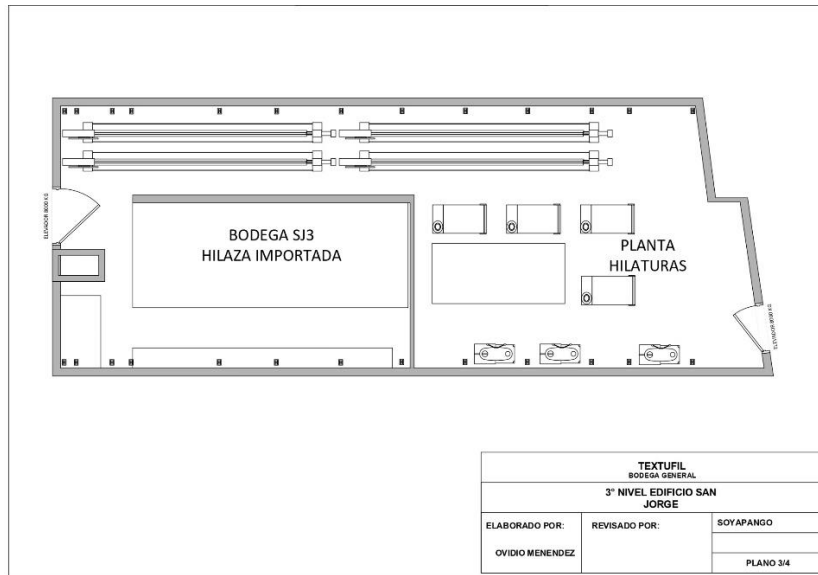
Distribución en Planta Nivel 3 edificio San Jorge
